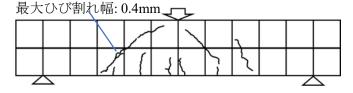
ひび割れ観測図 (載荷後:S-Side)
